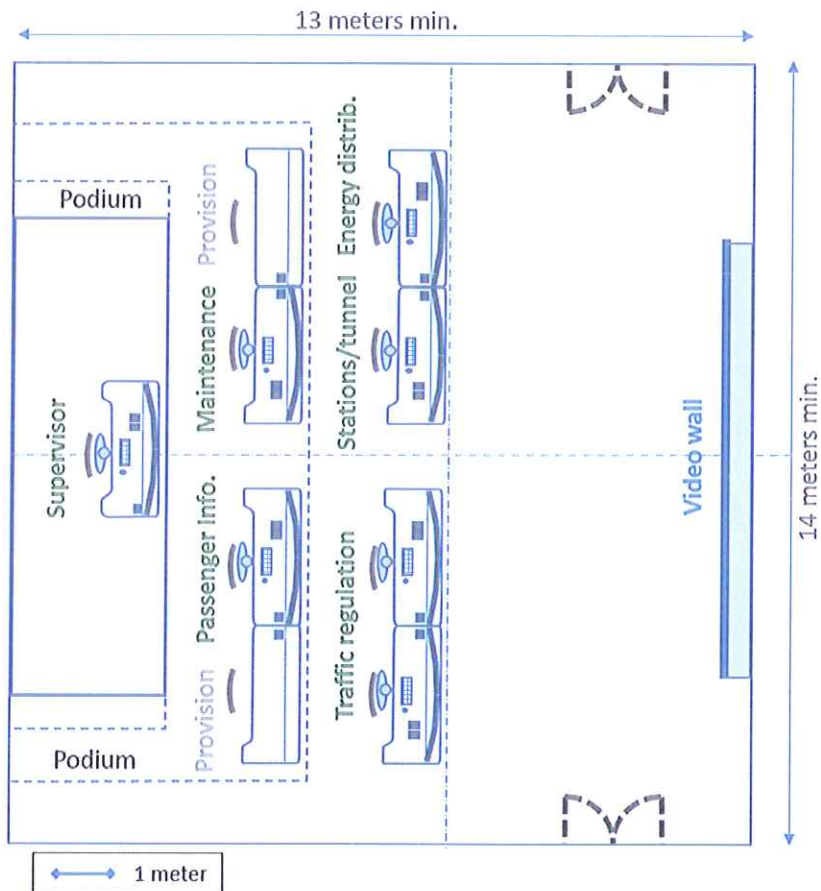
Plan amenajare camera principala DC. Propunere
